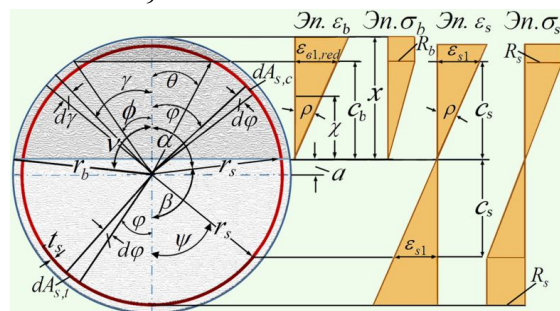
Напряжённое состояние расчётного сечения при упругопластической работе сжатого бетона и арматуры
